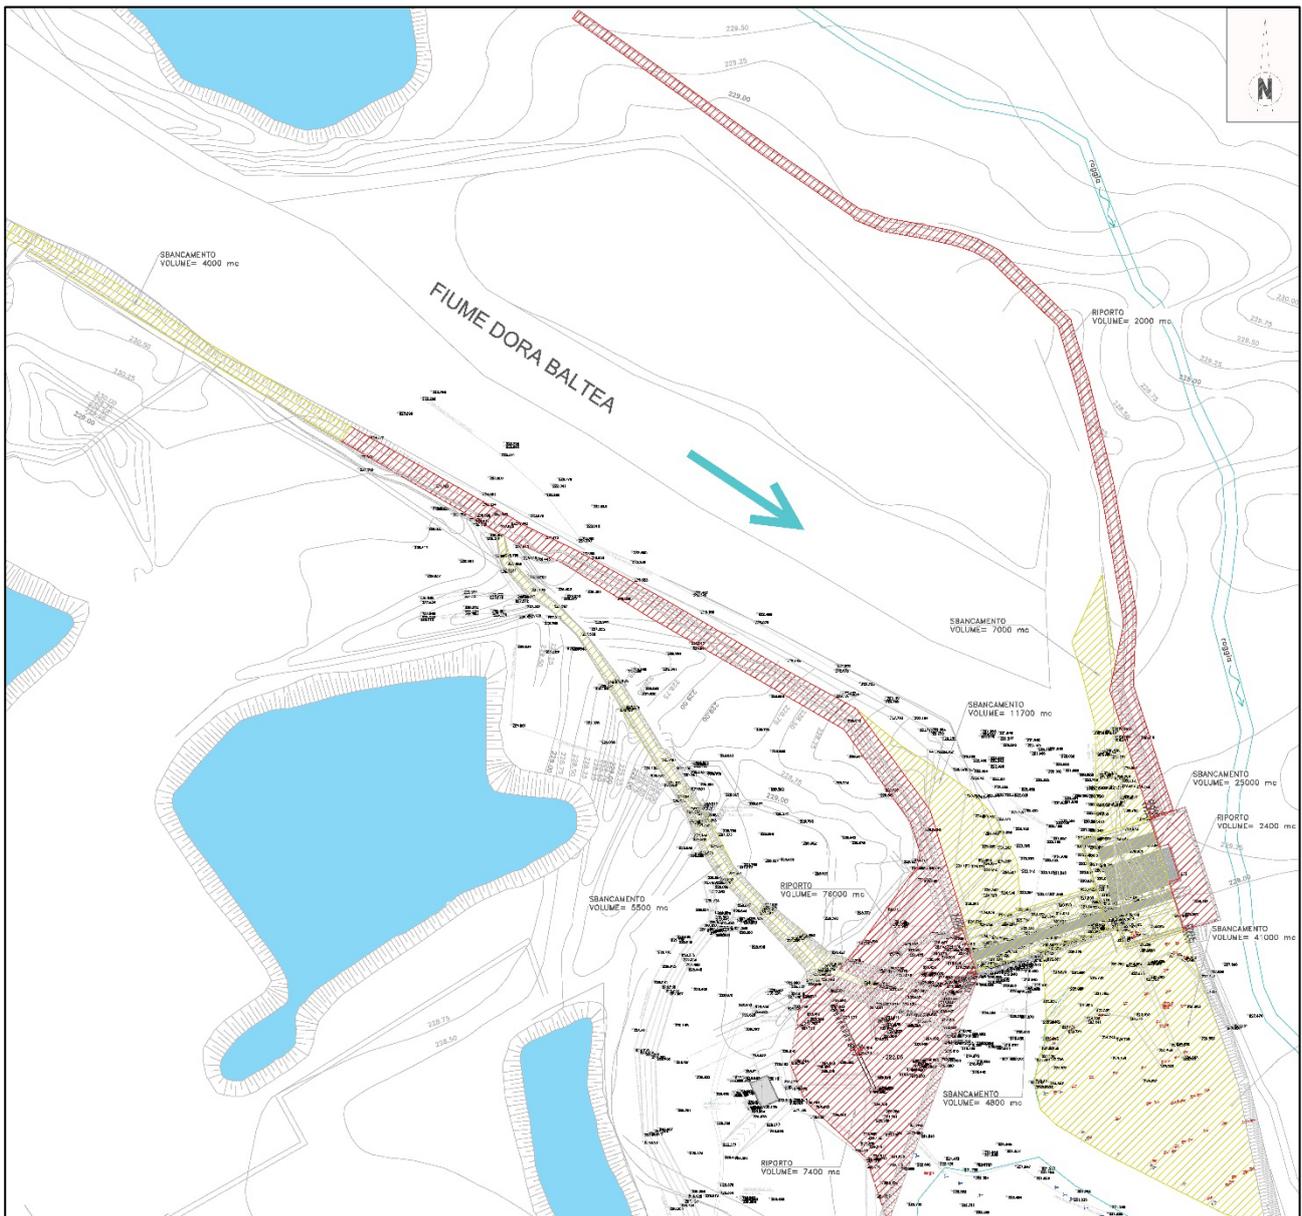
PLANIMETRIA SCAVI (IN ROSSO) E RIPORTI (IN GIALLO)
